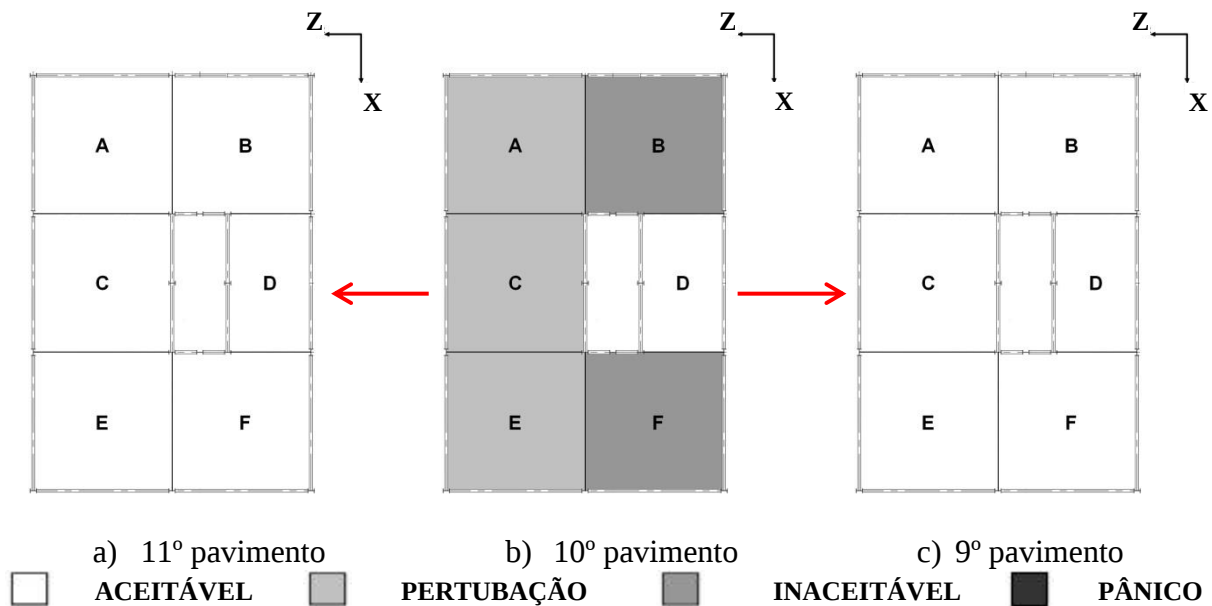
Percepção da vibração no 10° pavimento e pavimentos vizinhos devido ao MC-I: aeróbica
